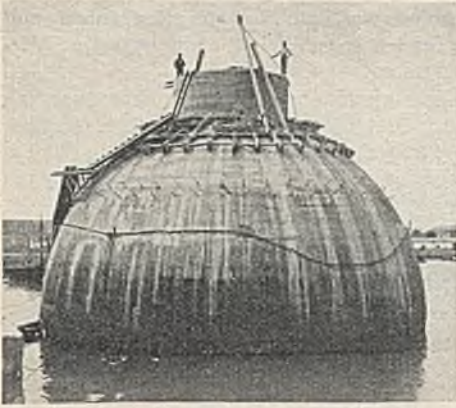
Das als Senkkasten ausgebildete fertig betonierte Pumpenhaus.
